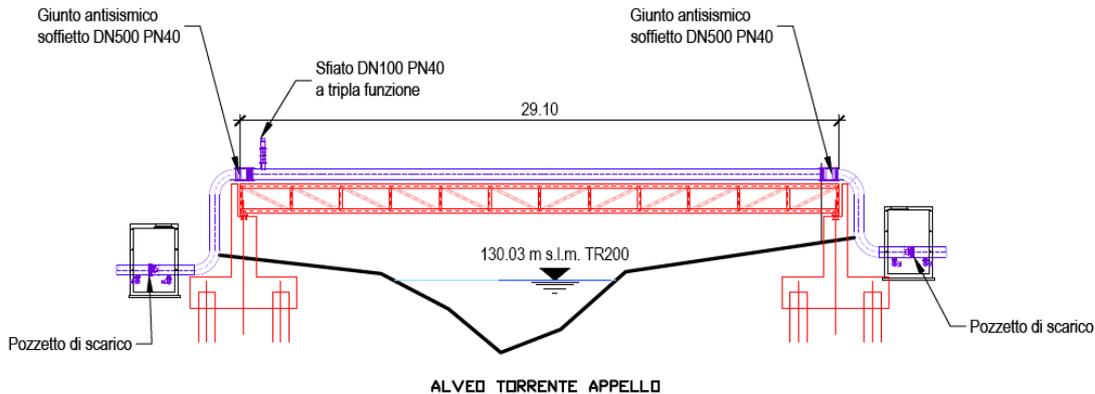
Sezione longitudinale attraversamento aereo di progetto sul Fiume Appello.
